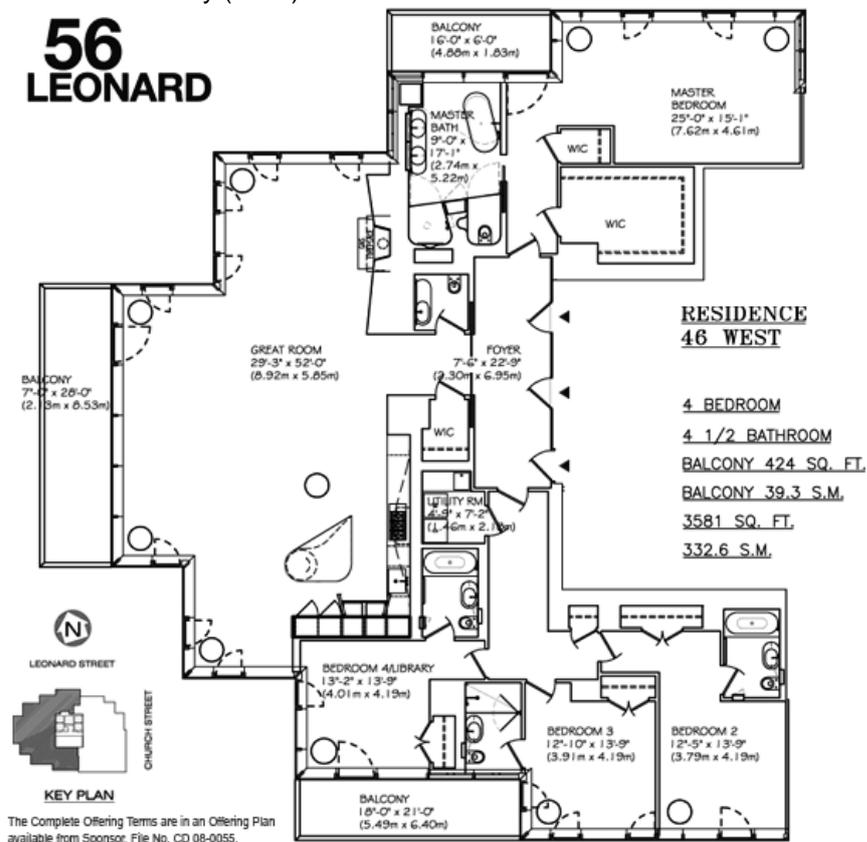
Planta com 332,6 m<sup>2</sup> e 4 quartos
